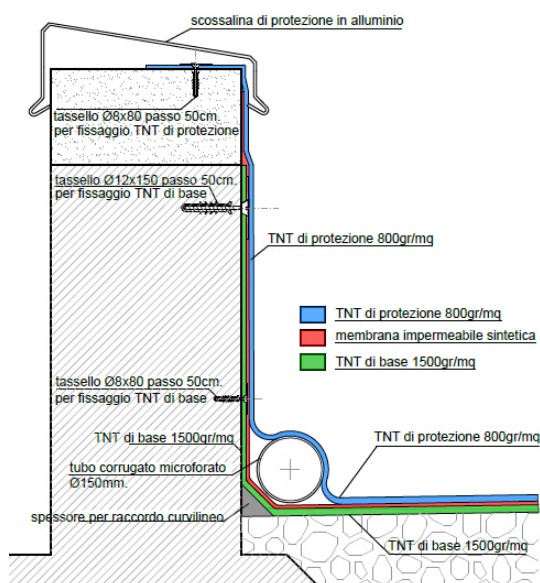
Posa del TNT di protezione (strato di colore azzurro) del peso di 800 gr/mq sul parapetto/timpano
